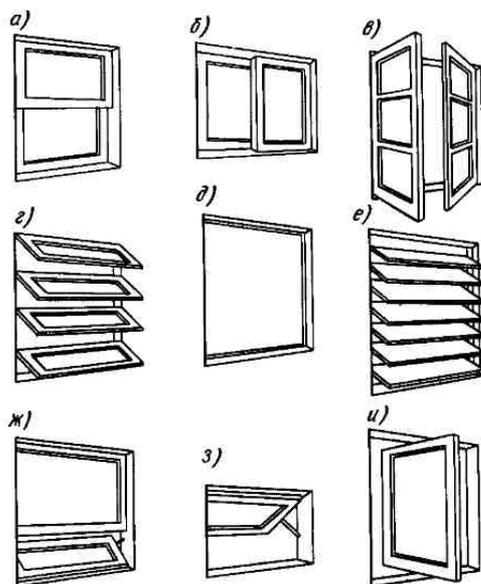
Виды окон по способу открывания: а — двойное раздвижное, б — раздвижное, в — створчатое, г — верхнеподвесное, д — глухое, е — жалюзийное, ж — с нижнеподвесной створкой, з — верхнеподвесное подвальное, и — на цапфах
